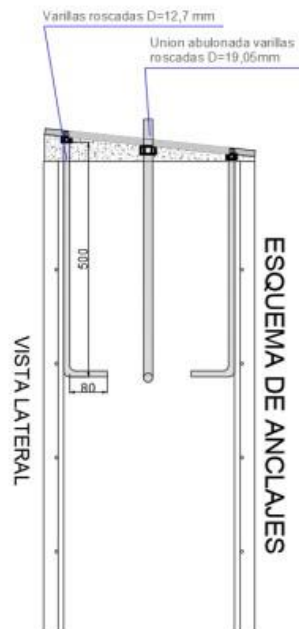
Vista lateral y esquema de anclajes. Detalle de unión viga metálica - columna de H[•]A[•]
